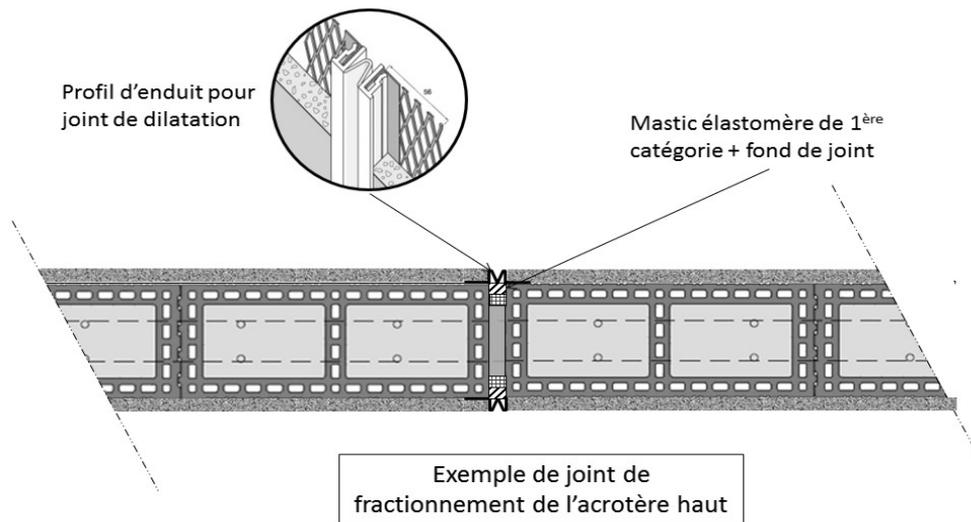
Exemple de traitement des joints (coupe horizontale)
